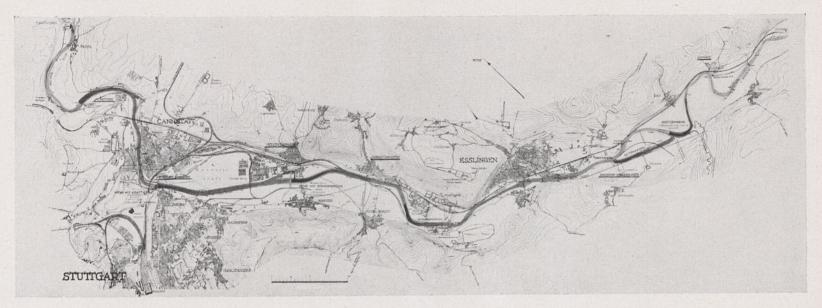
Lageplan der Staustufen Münster-Cannstatt, Unter- und Obertürkheim, Oberestlingen.
